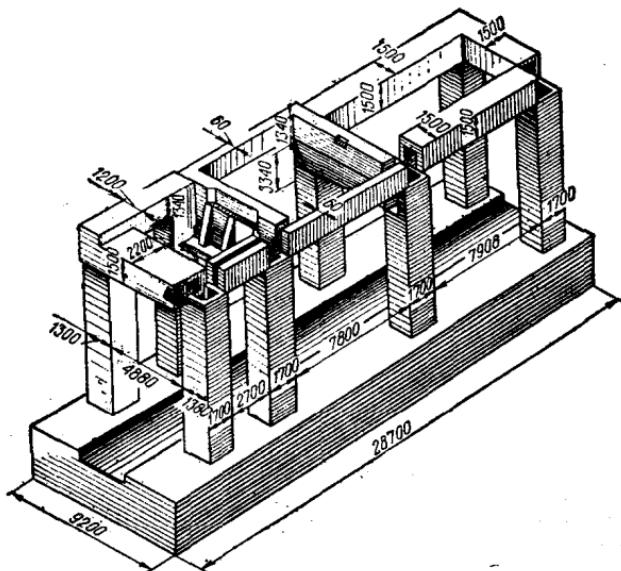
容量为15万千瓦汽轮机组的装配式钢筋混凝土基础
